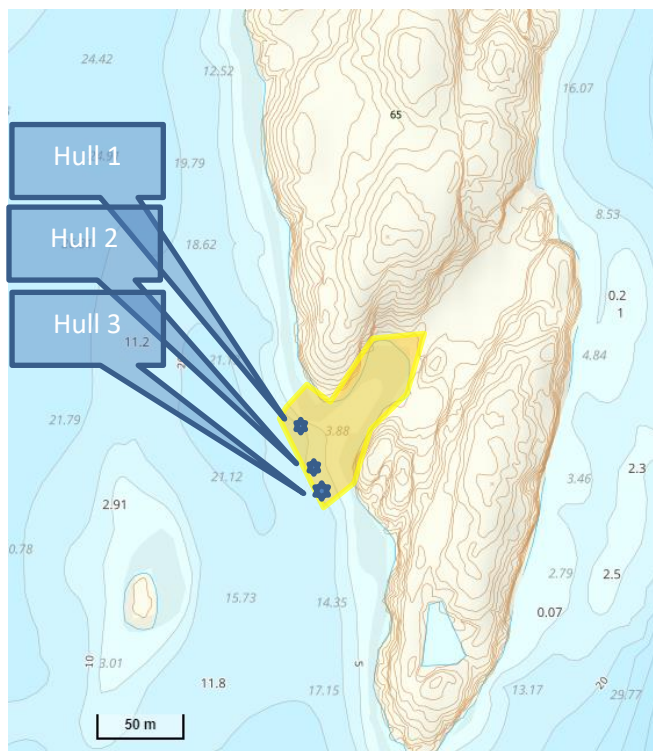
Planlagte fylling Lille Rosøy, ★ : utførte prøveboringer
